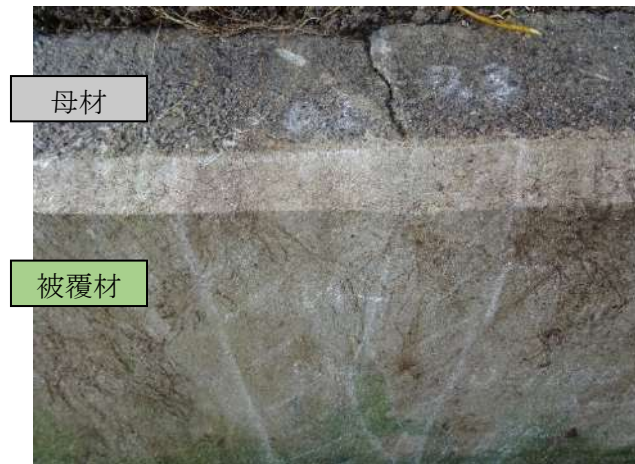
母材に発生したひび割れの事例
